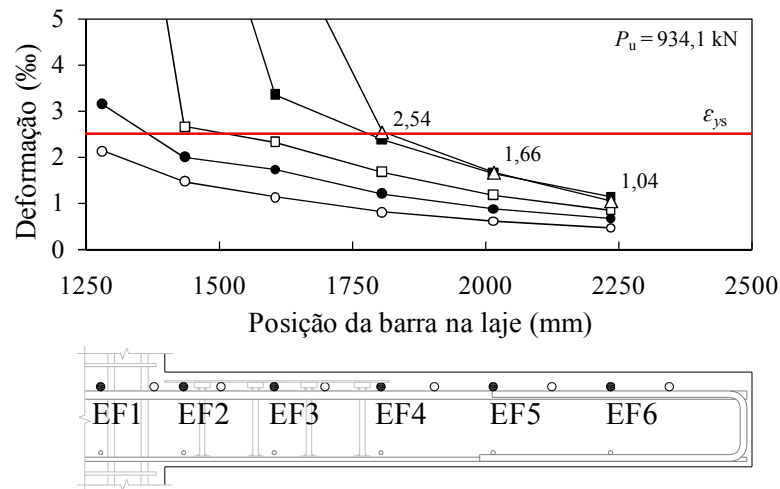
Deformações nas armaduras de flexão da laje LS08
